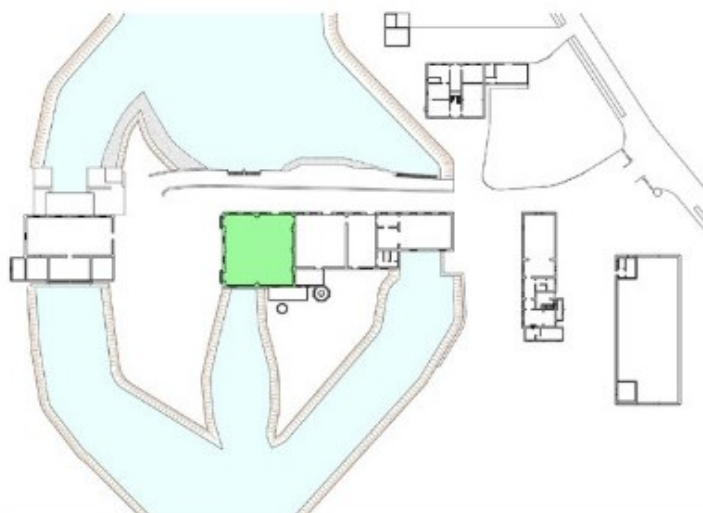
Planimetria attuale dell'impianto idrovoro di Santa Margherita, evidenziando la principale sala macchine
